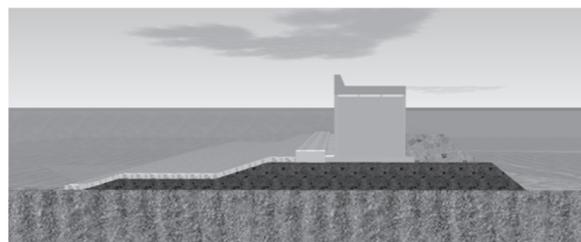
重力式護岸(建設中は防波堤の機能を有する)の施工
